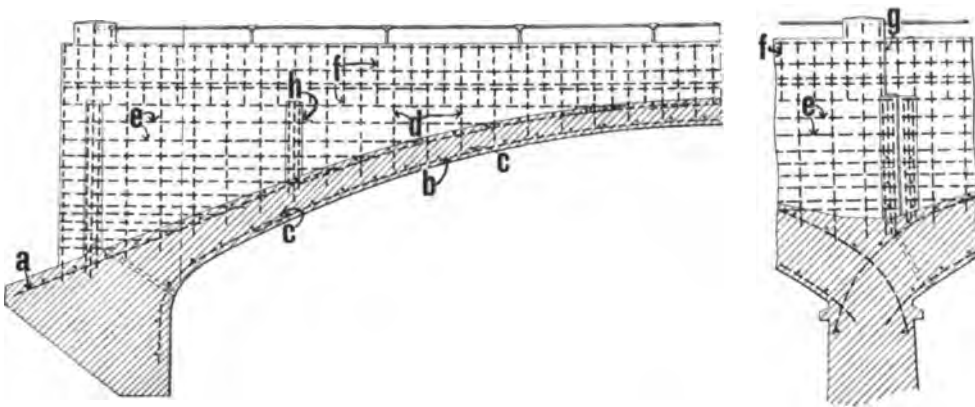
Eisenbetonbrücke von Pollasky in Californien.
